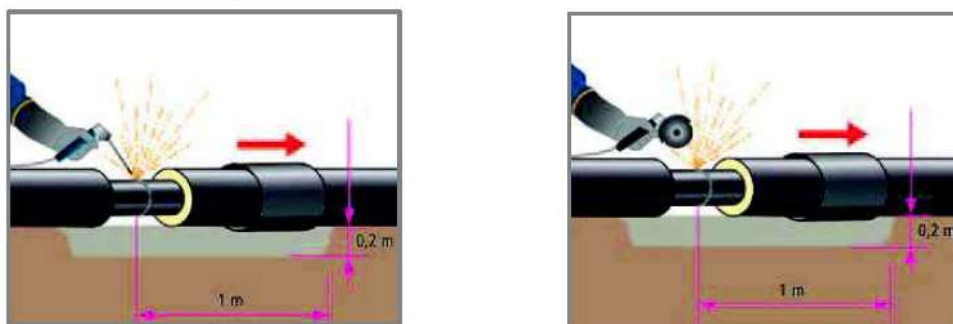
Schéma d'une opération de soudure
